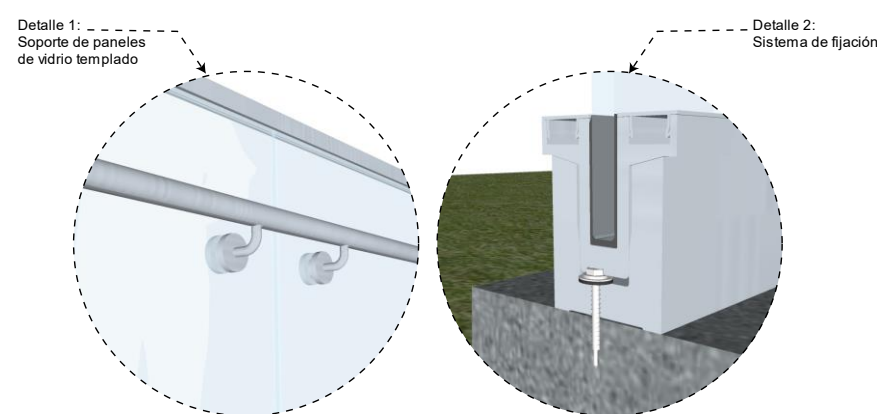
Detalle de soporte de paneles y sistema de fijación.
